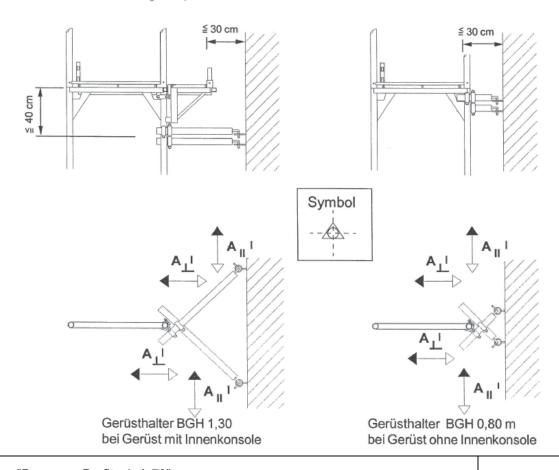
Einfache Gerüsthalter werden in kurzer und langer Ausführung nur am inneren Ständer des Alu-Stellrahmens BASR mit einer Normalkupplung angeschlossen. Sie nehmen Zug- und Druck-Ankerkräfte rechtwinklig zur Fassade auf.
